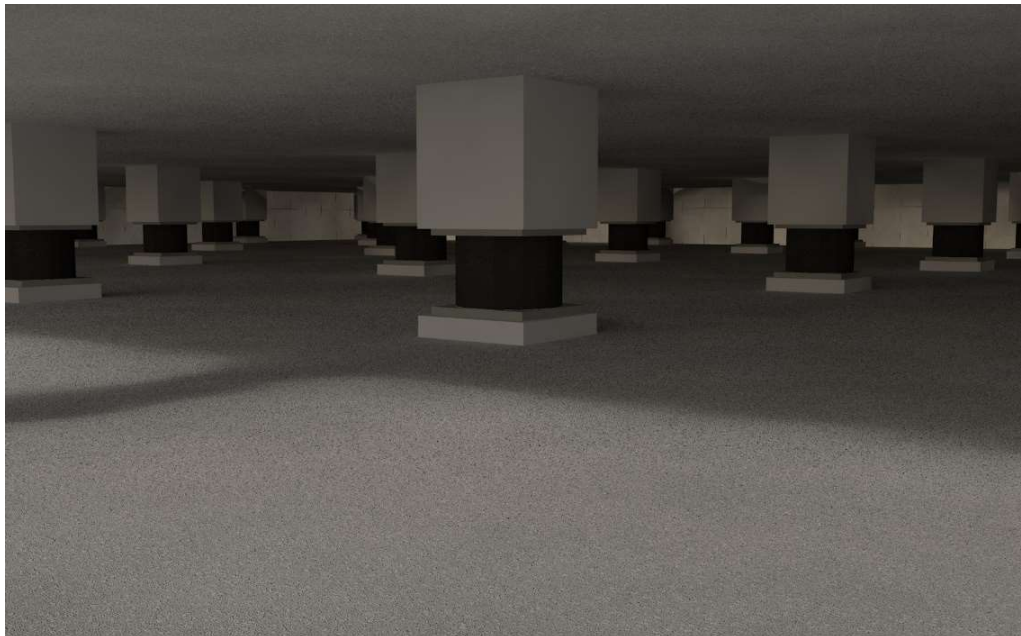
Vista 3D de los aisladores sísmicos de base ubicados en el sótano.
